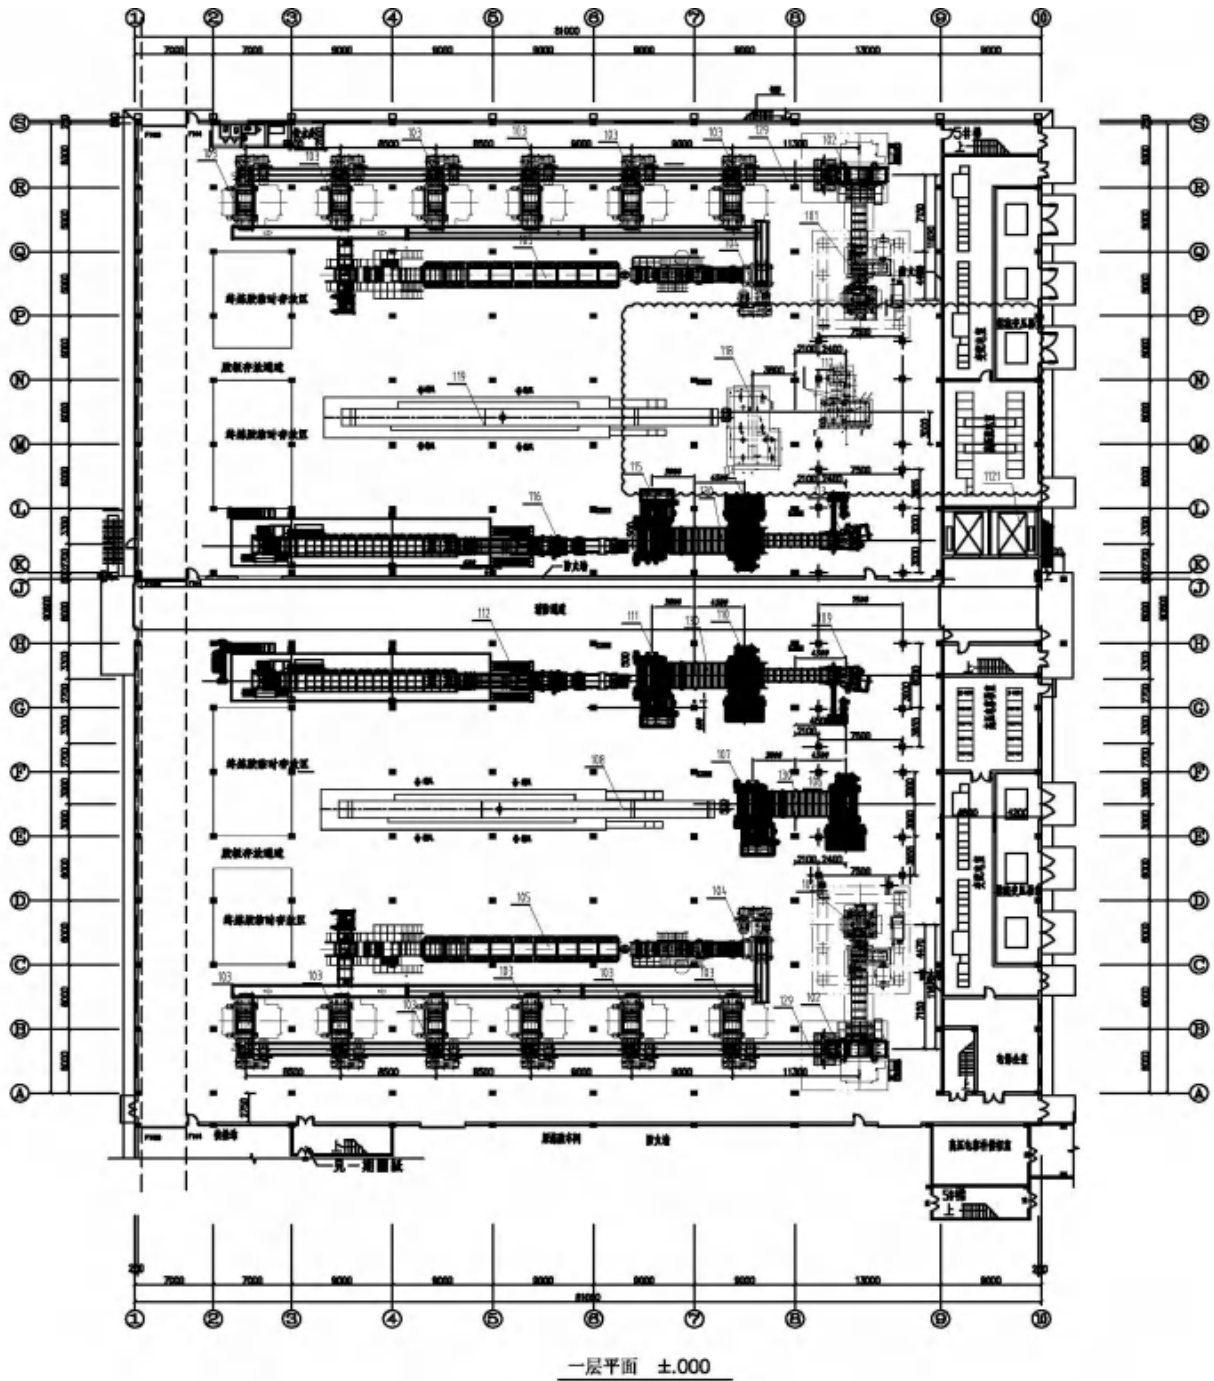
(1) 炼胶车间 1 层平面布局 (局部)
